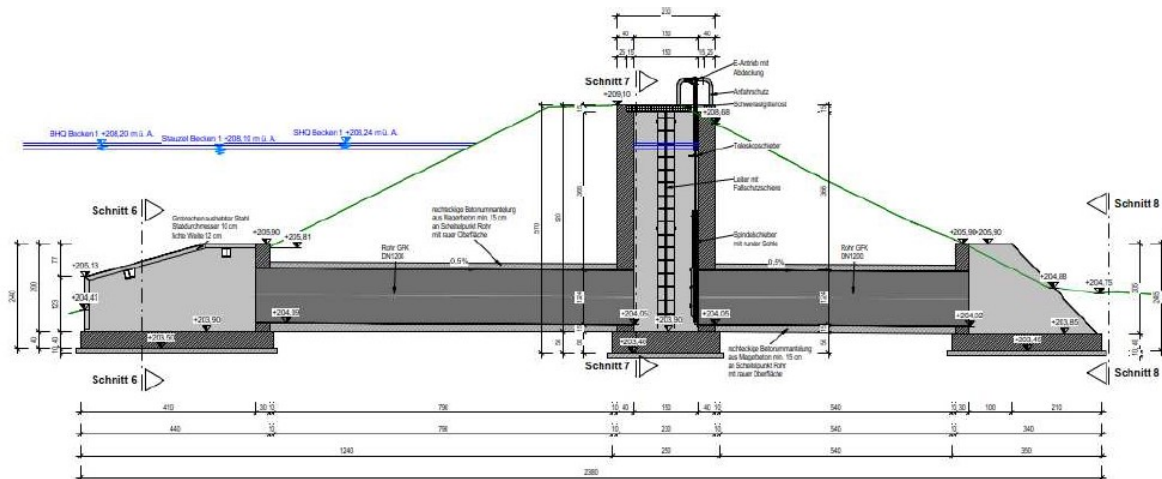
Schnitt durch des Auslaufbauwerk ([13], Kap.7.5.2, Abb.39)
